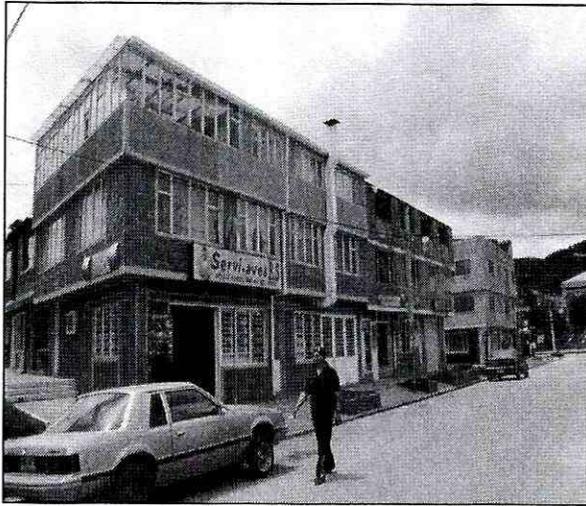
Ampliación constructiva de viviendas, hasta 3 y 4 niveles hacia la parte posterior, de las mismas, en especial hacia la zona de patio
